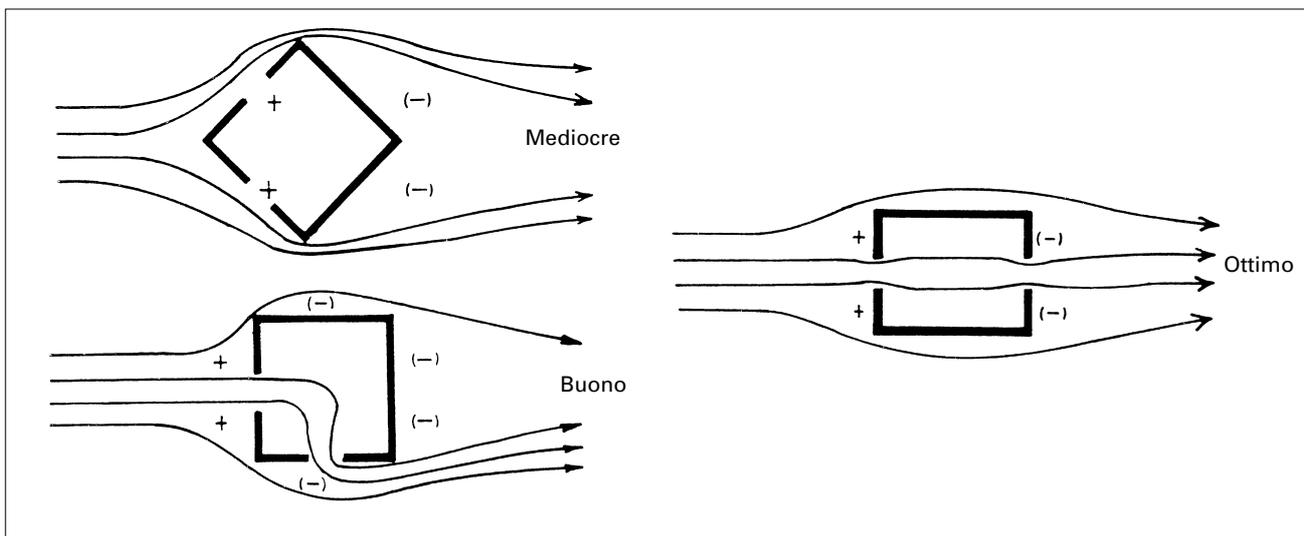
una ventilazione trasversale tra aperture situate su muri opposti è la soluzione migliore. Una ventilazione tra aperture situate su muri adiacenti può essere efficace oppure irrilevante a seconda della direzione del vento [12].
